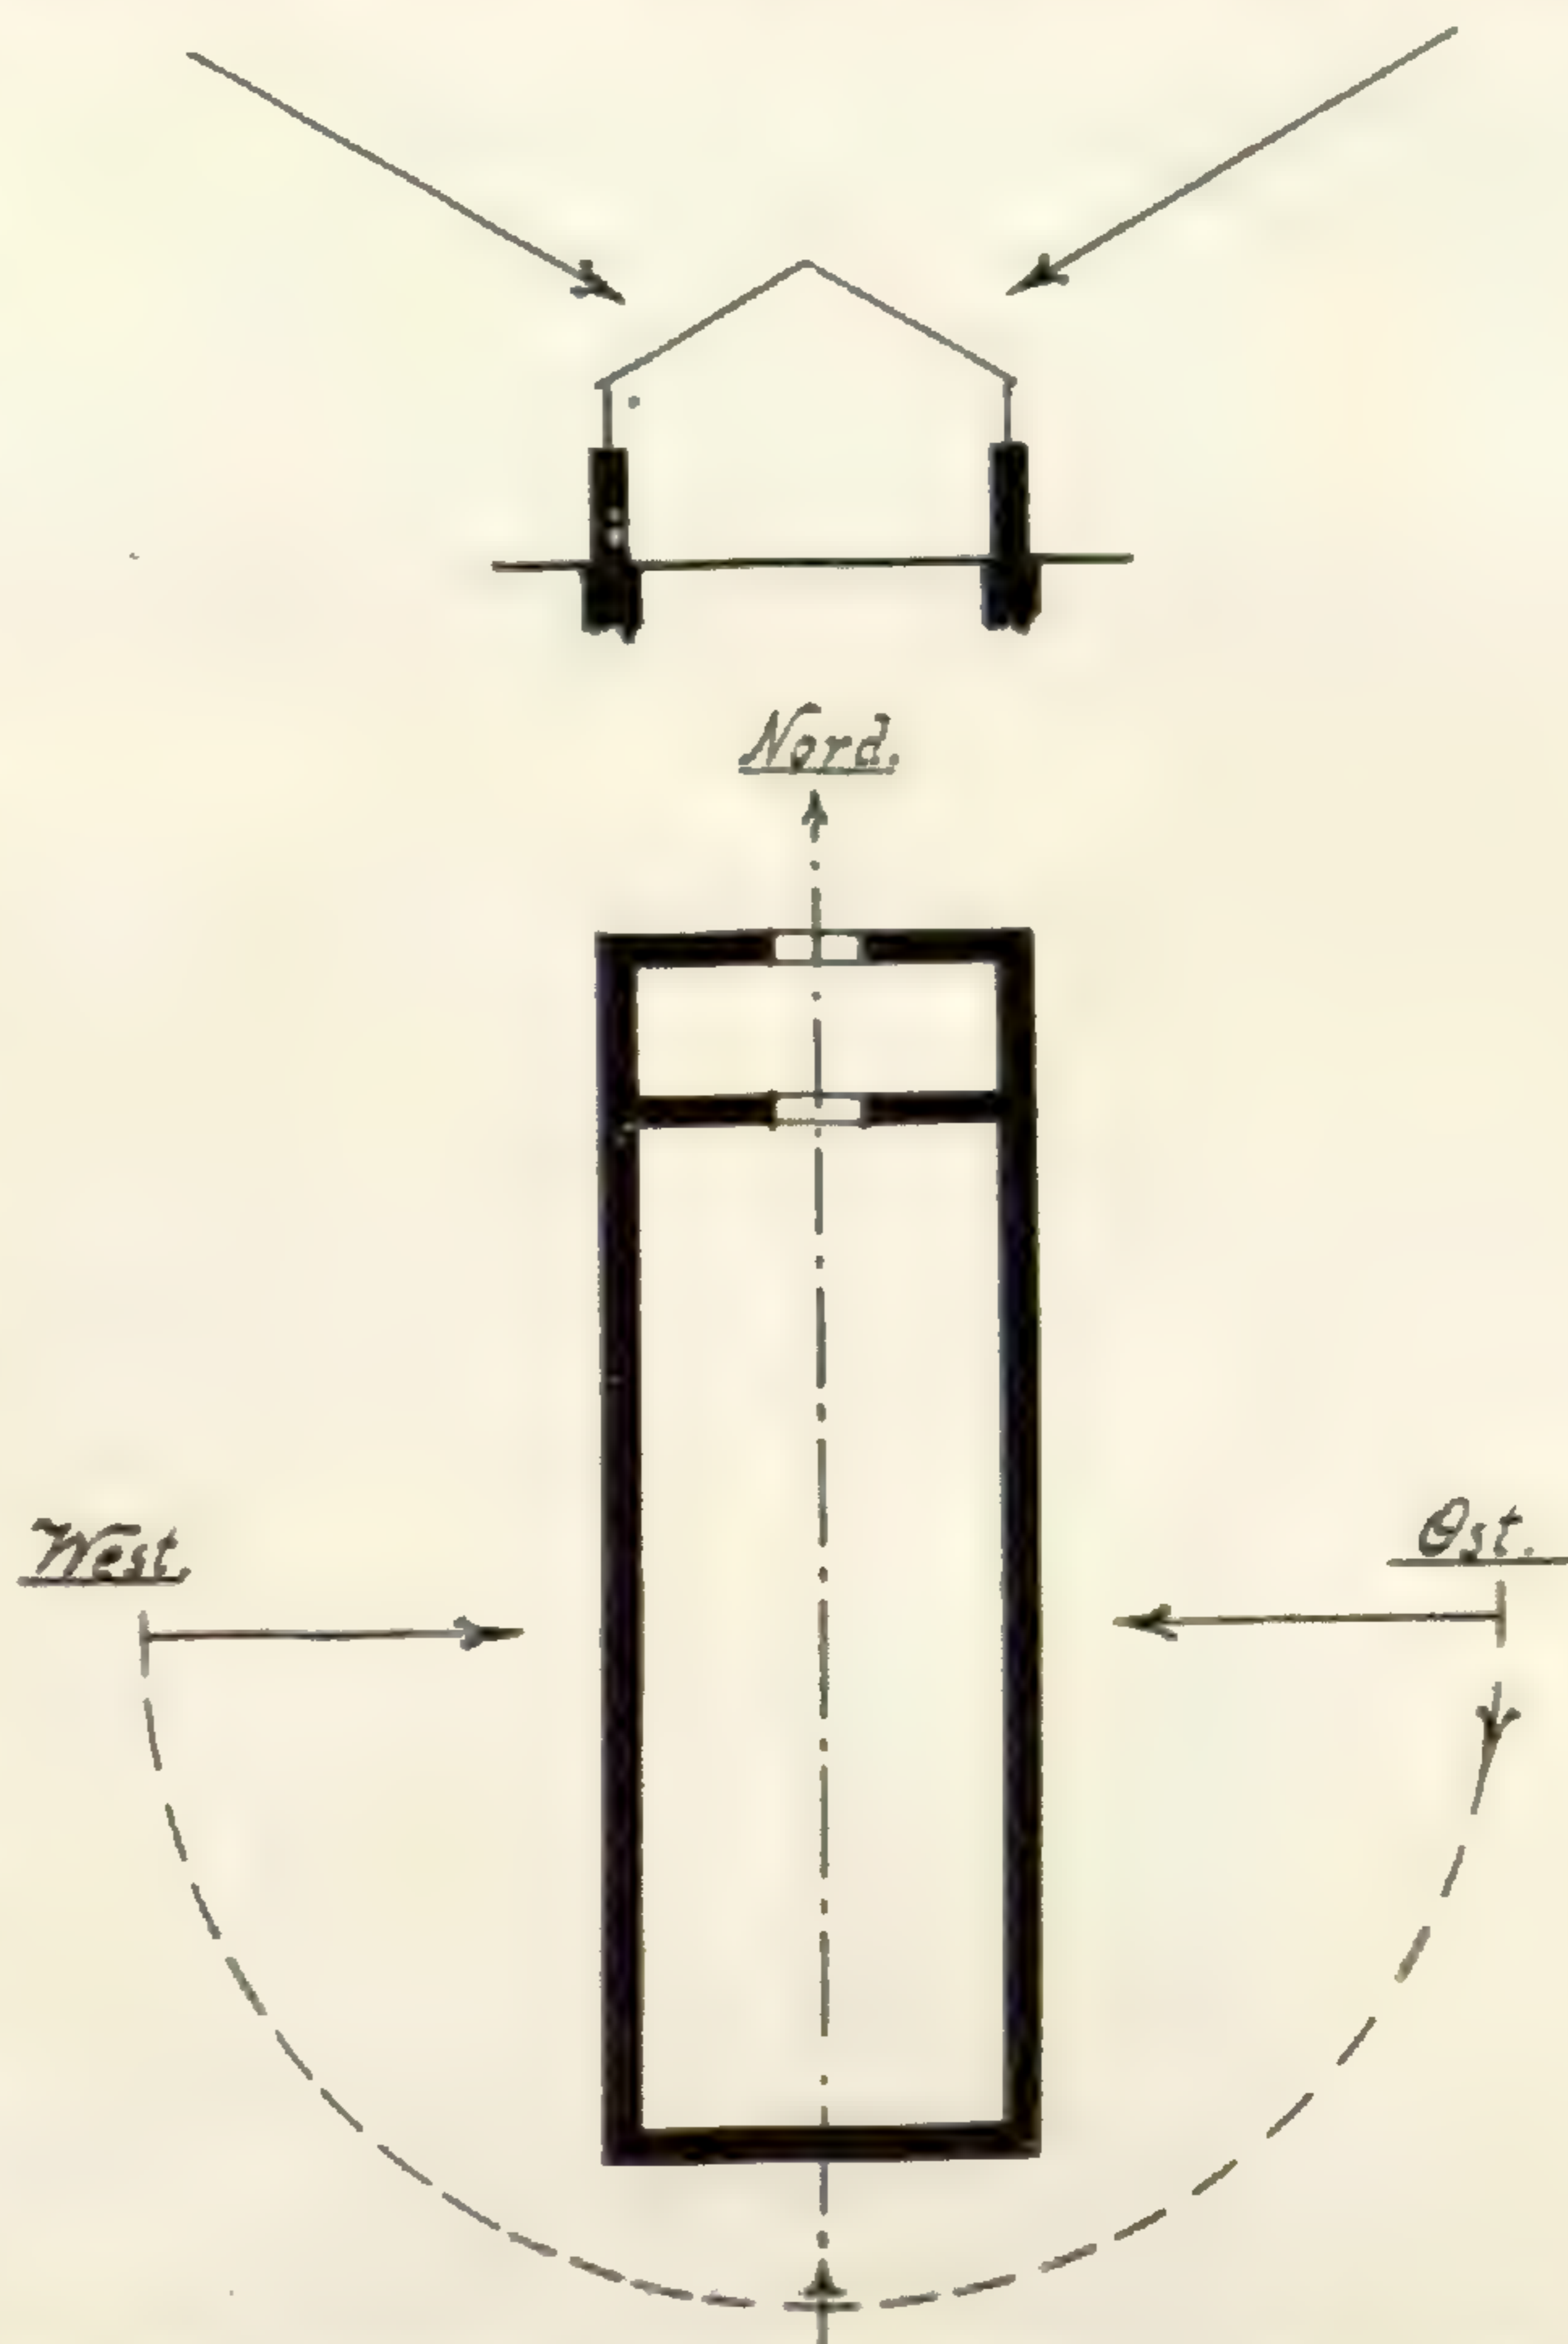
Orchideenhaus-Querschnitt und Grundriß
